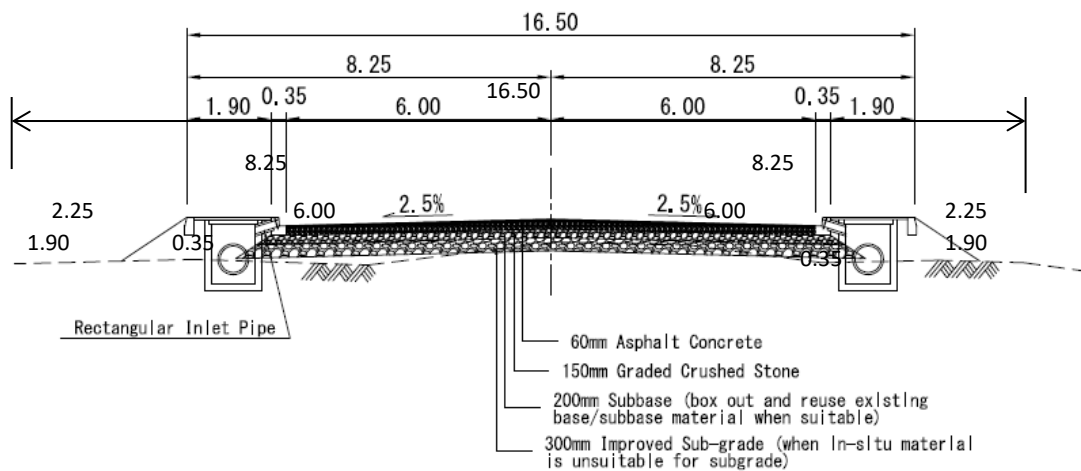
道路標準断面図 (計画) Road Q、Road F-1b/1c (橋梁 No.4、No.7)
